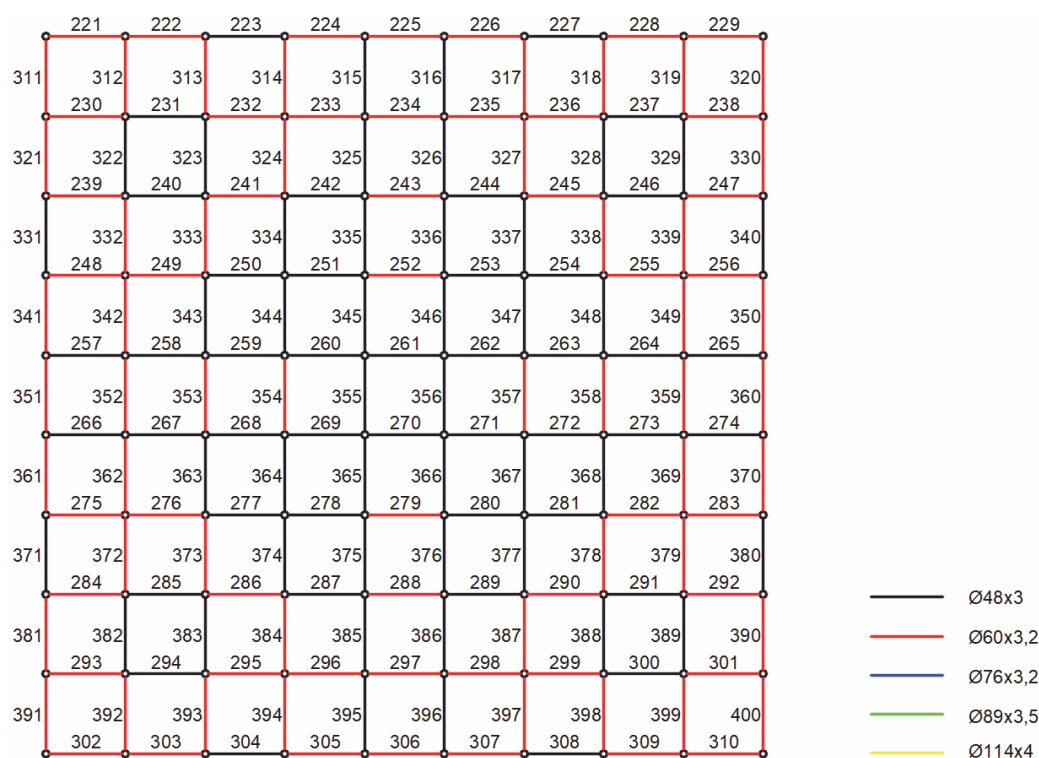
Схема раскладки и нумерация элементов нижнего пояса СП 30-400.
